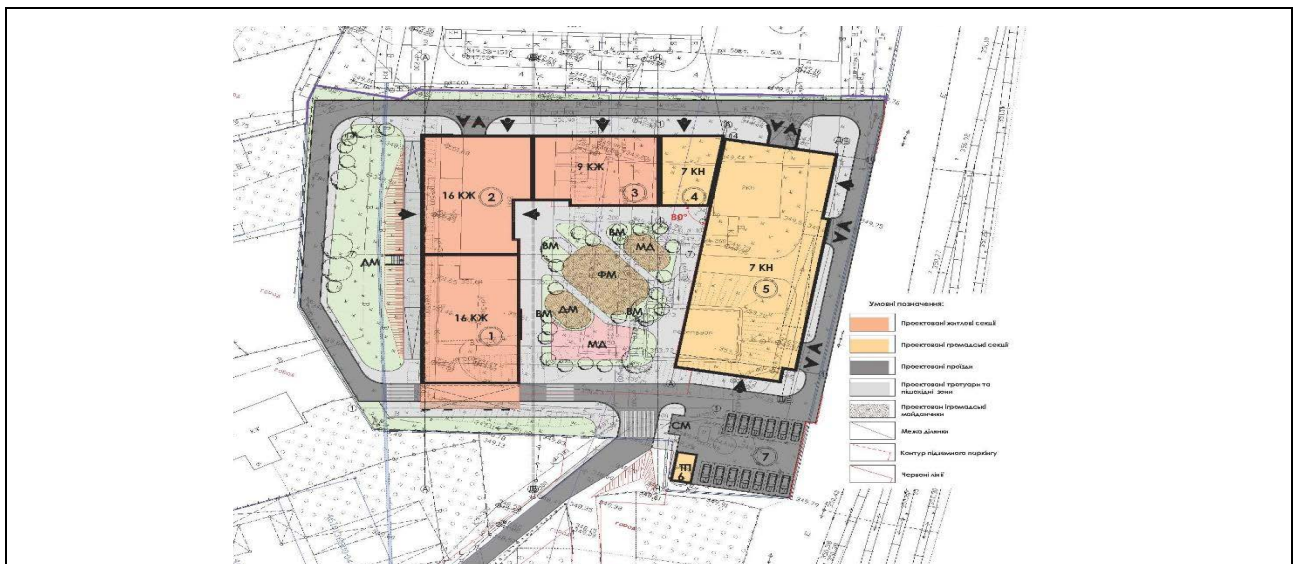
ЖК у Львові на вул. Соняшниковій, 32. Схема функціонально-планувального вирішення об'єкту.
